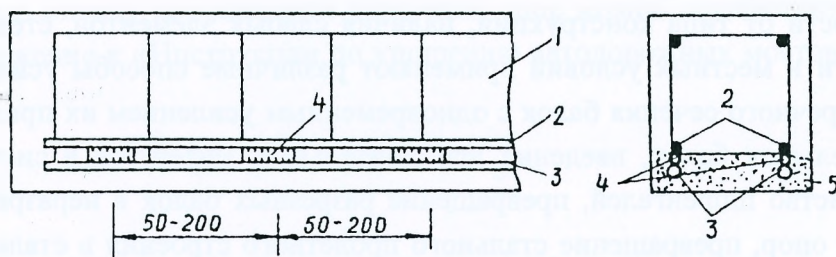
Усиление балок постановкой дополнительной арматуры: 1 — балка; 2 — рабочая основная арматура; 3 — дополнительная арматура, 4 — коротыши; 5 — дополнительный слой бетона.
